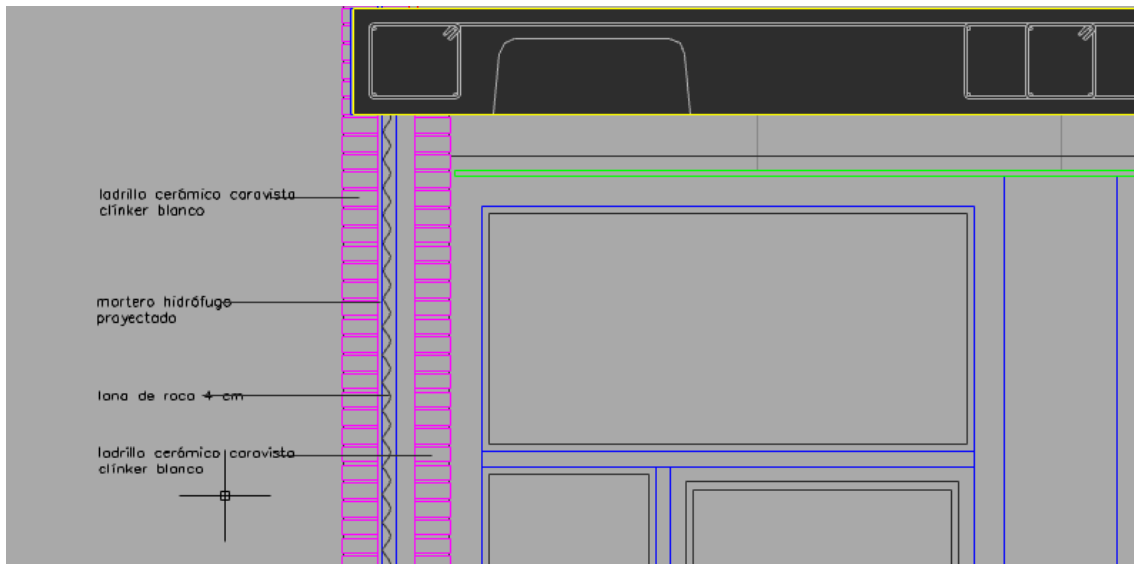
obtenida del plano de detalles constructivos E2.3_32.6 del Proyecto de Ejecución.
